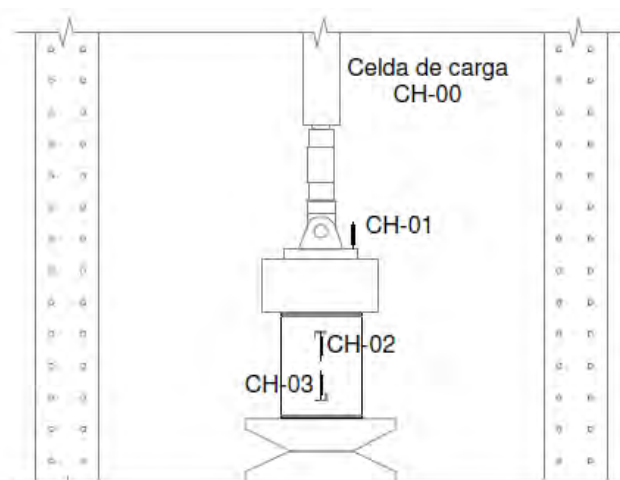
Esquema de ensayo de pilas de adobe
